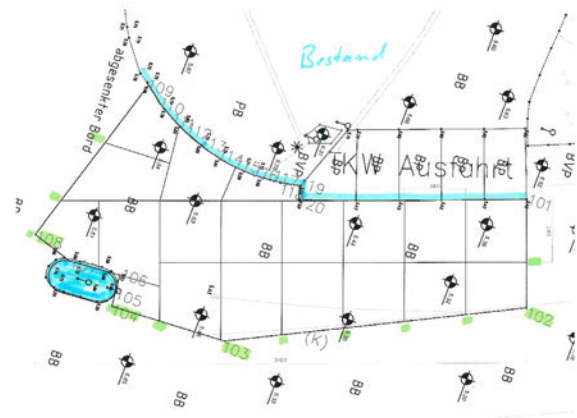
Konstruktionsplan zur Neugestaltung der Werksausfahrt mit Betonfertigteilen (Quelle: BTE stelcon GmbH)
